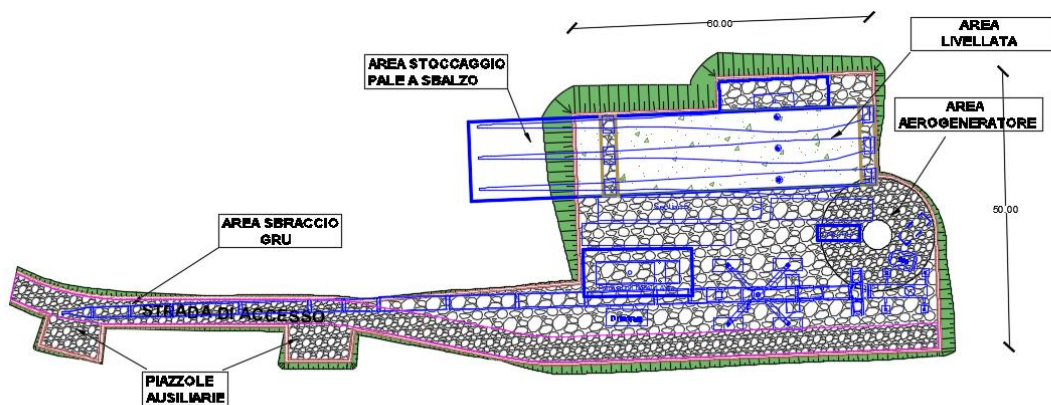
Planimetria piazzola tipo in fase di esecuzione lavori
